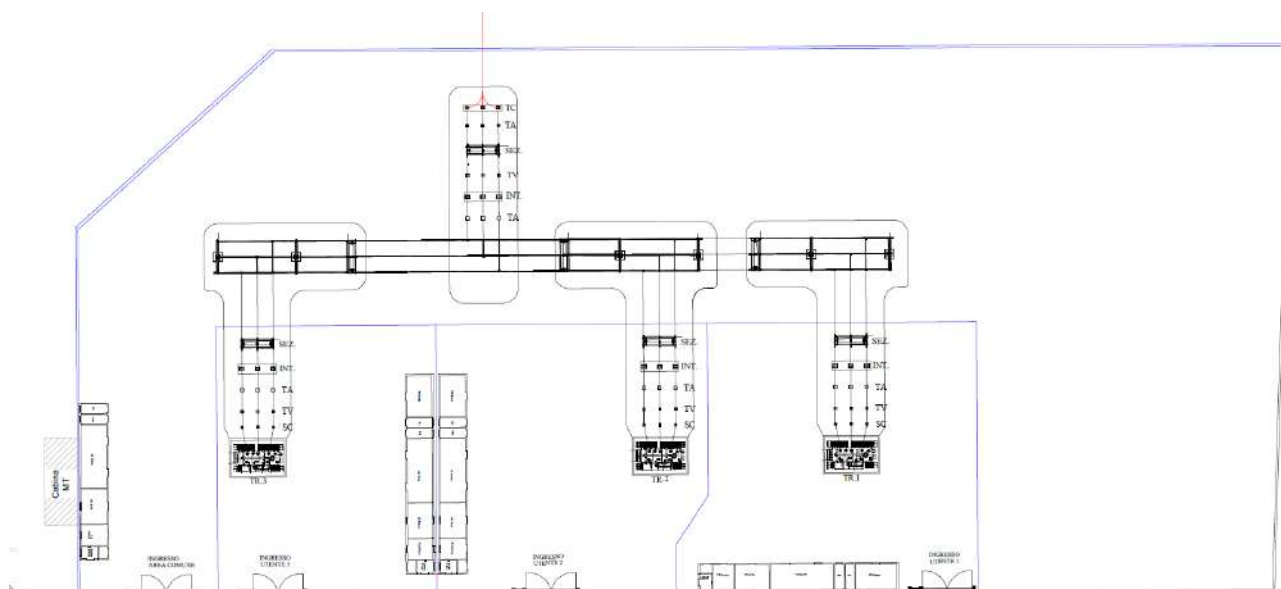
LAYOUT STAZIONE DI CONSEGNA AT
